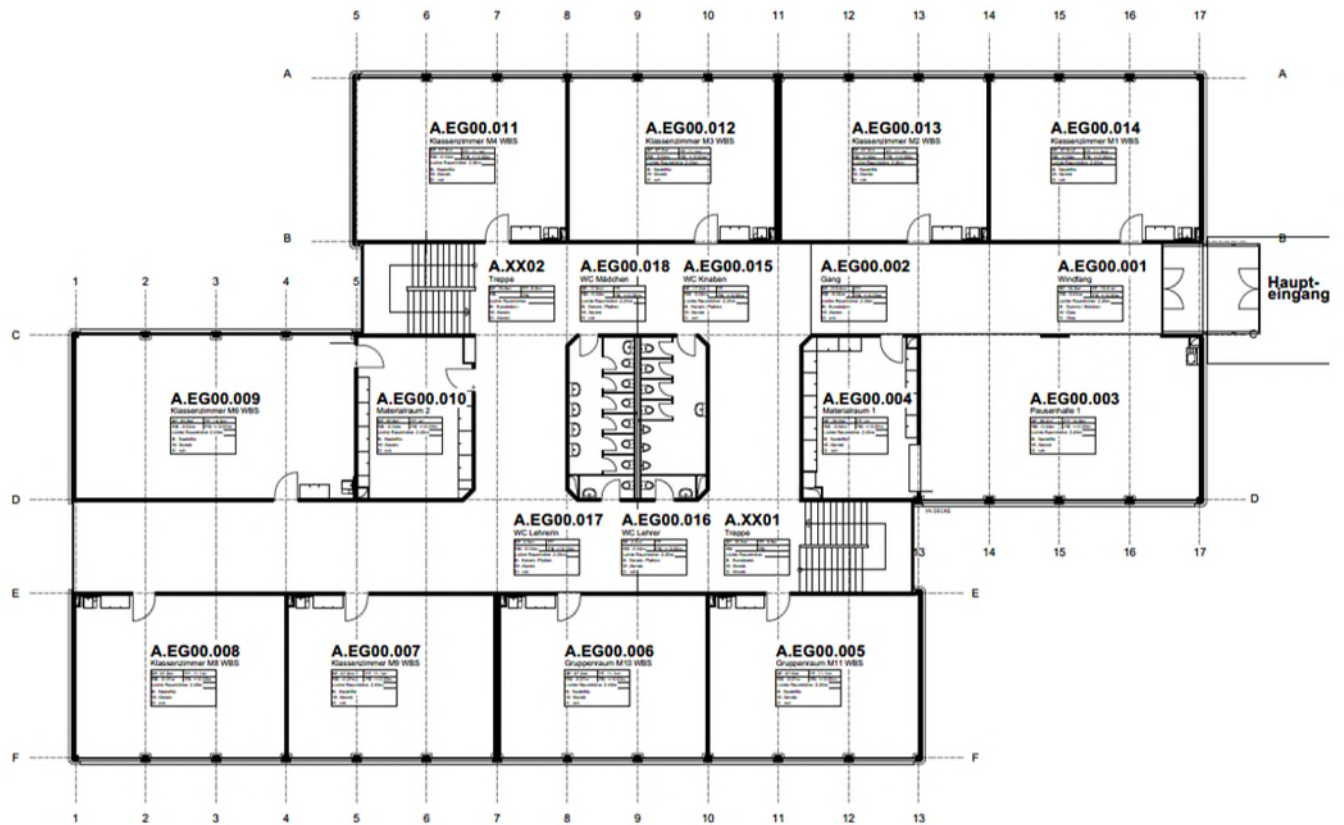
Raumbezeichnung / Raumstempel im Grundrissplan
